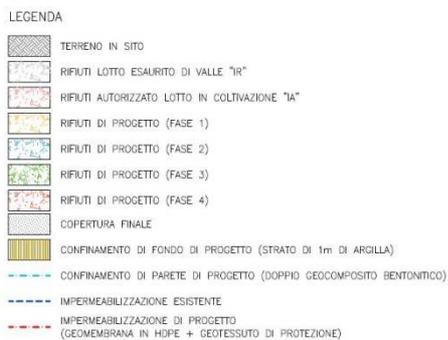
legenda delle sezioni tipologiche del progetto autorizzato
